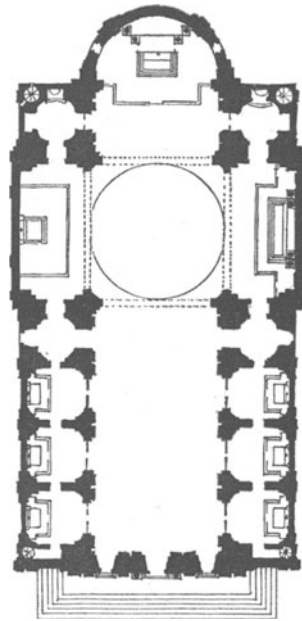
Grundriss der Kirche del Gesù in Rom.
